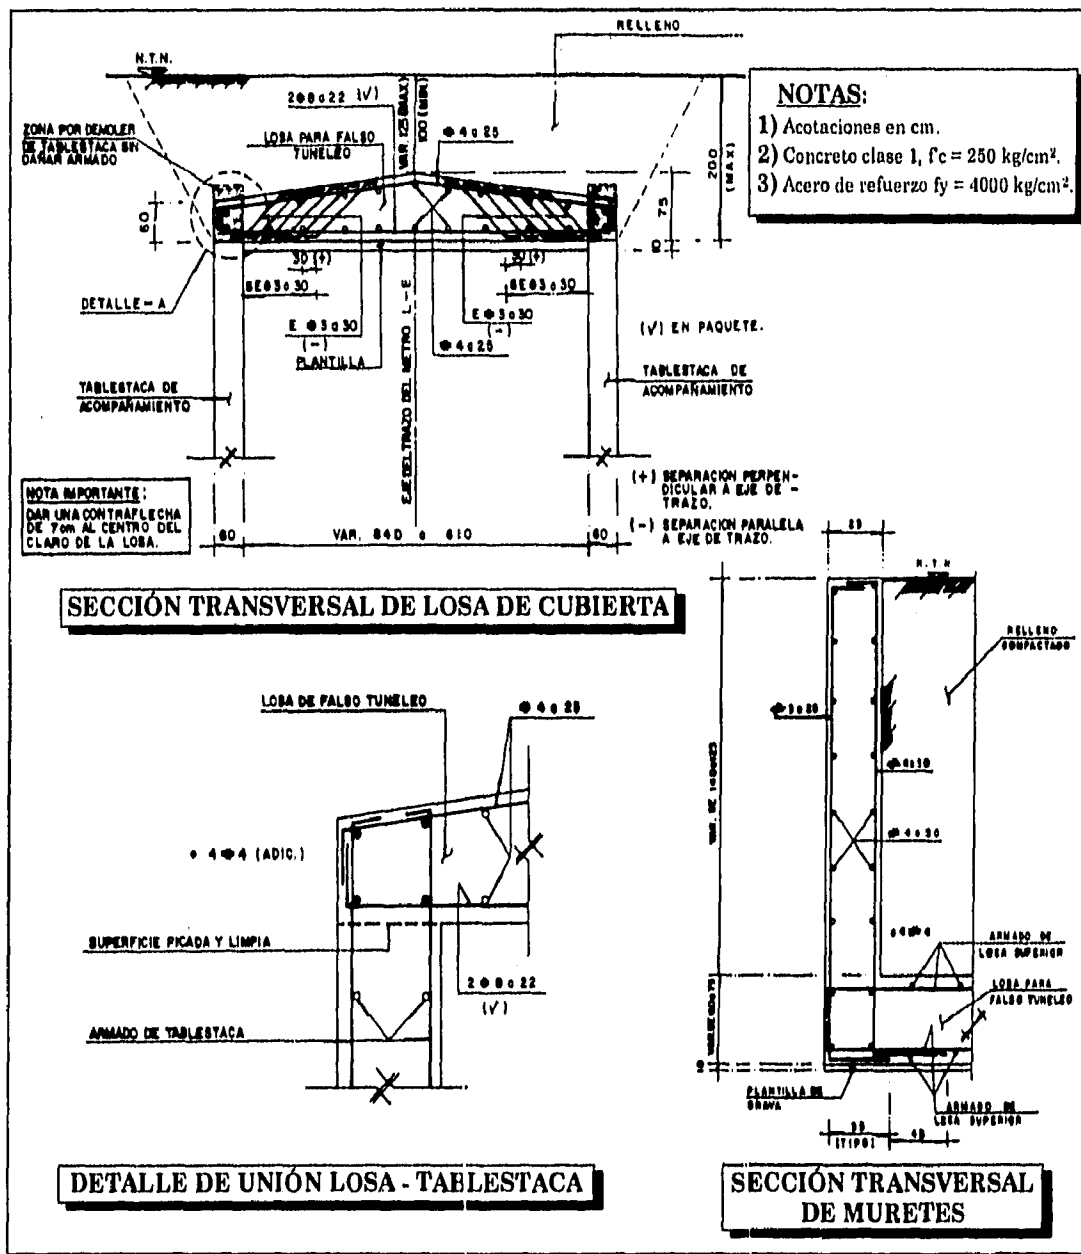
Losa de cubierta y muretes para tuneleo falso.
